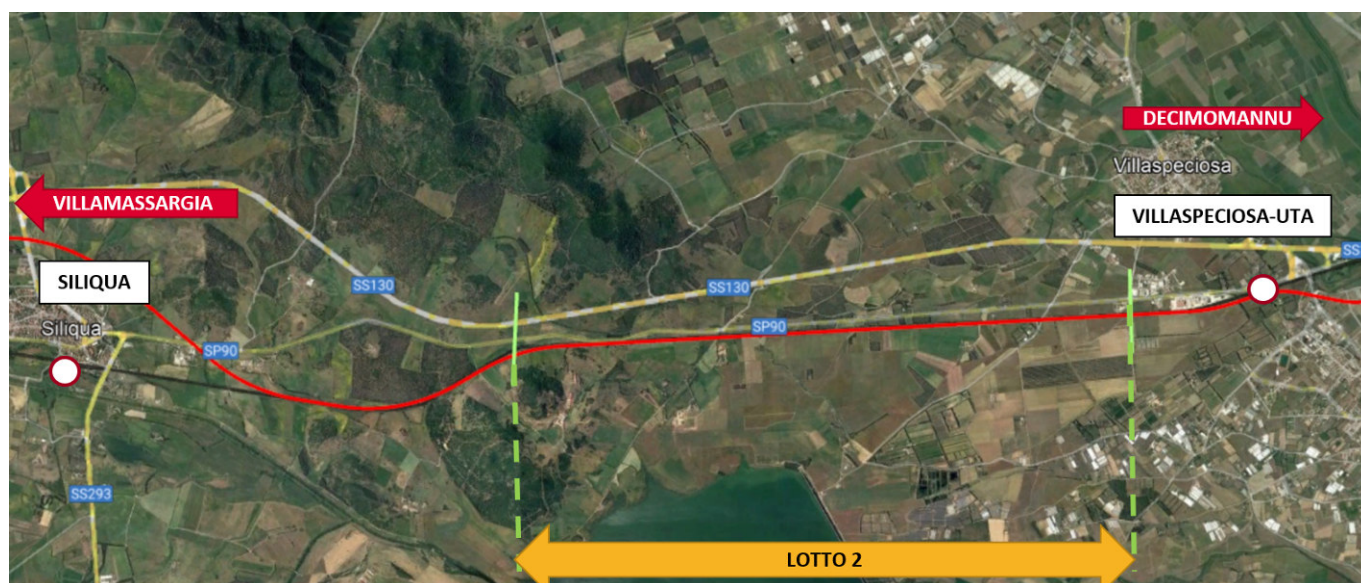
Planimetria del tracciato in oggetto - Google Earth
